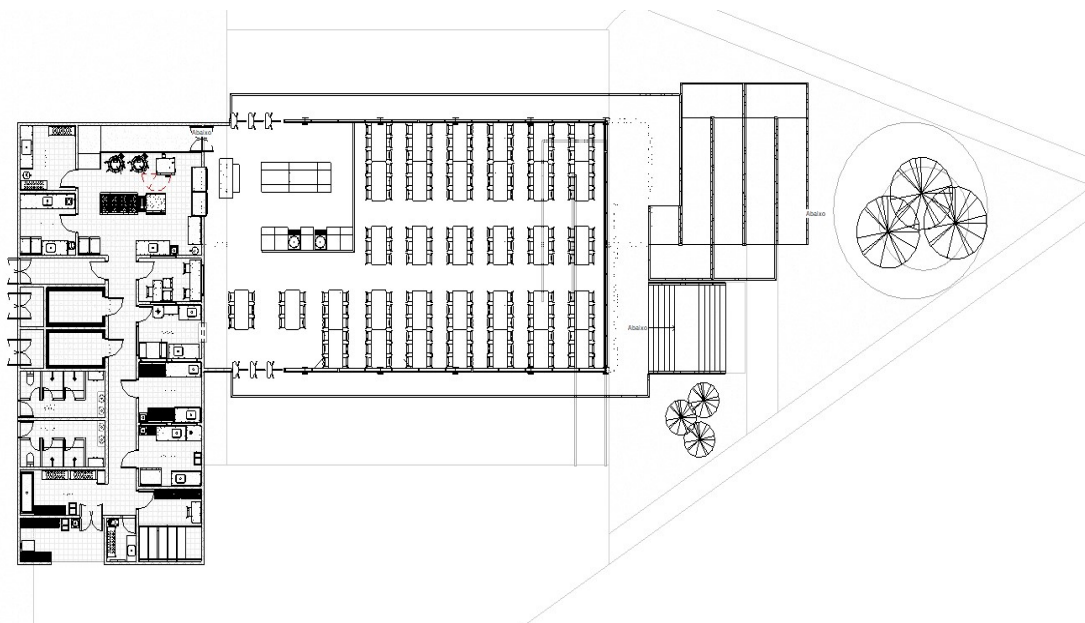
Planta baixa do Pavimento Principal do Restaurante Fogão da Mata
